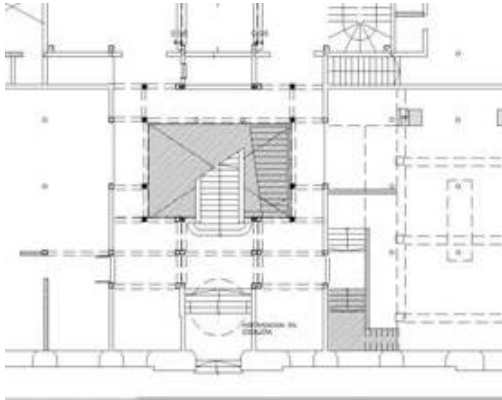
, 57 y 58 – Refuerzo de escalera de acceso y colocación de malla al patio central
